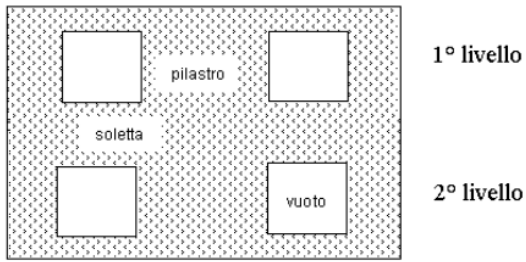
sezione di una coltivazione a camere e pilastri su più livelli con pilastri sovrapposti.
